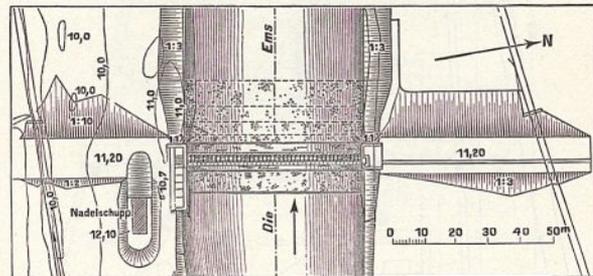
Lageplan der Wehrbaustelle bei Versen. 1:2000.
